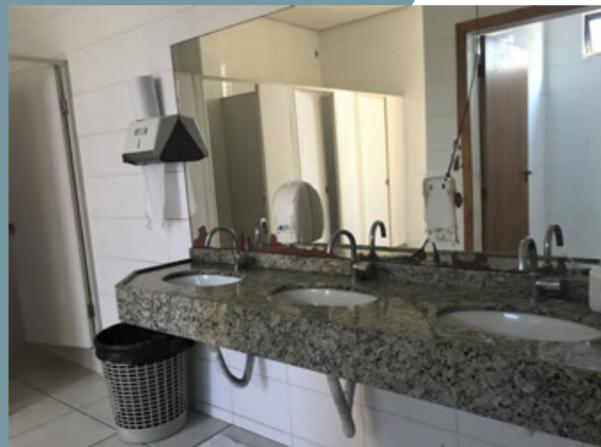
Lavatório do banheiro feminino. No espelho é possível notar rachaduras e oxidação. Fonte: Acervo pessoal.
